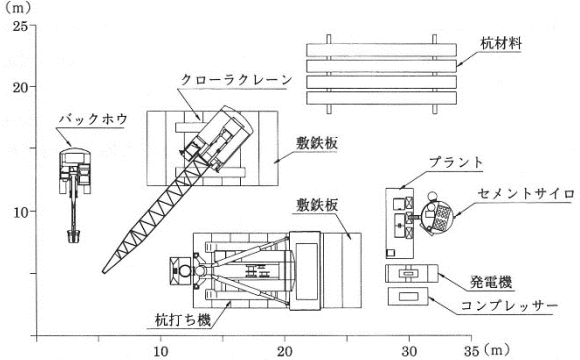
既製杭工法の標準的的施工ヤード例
